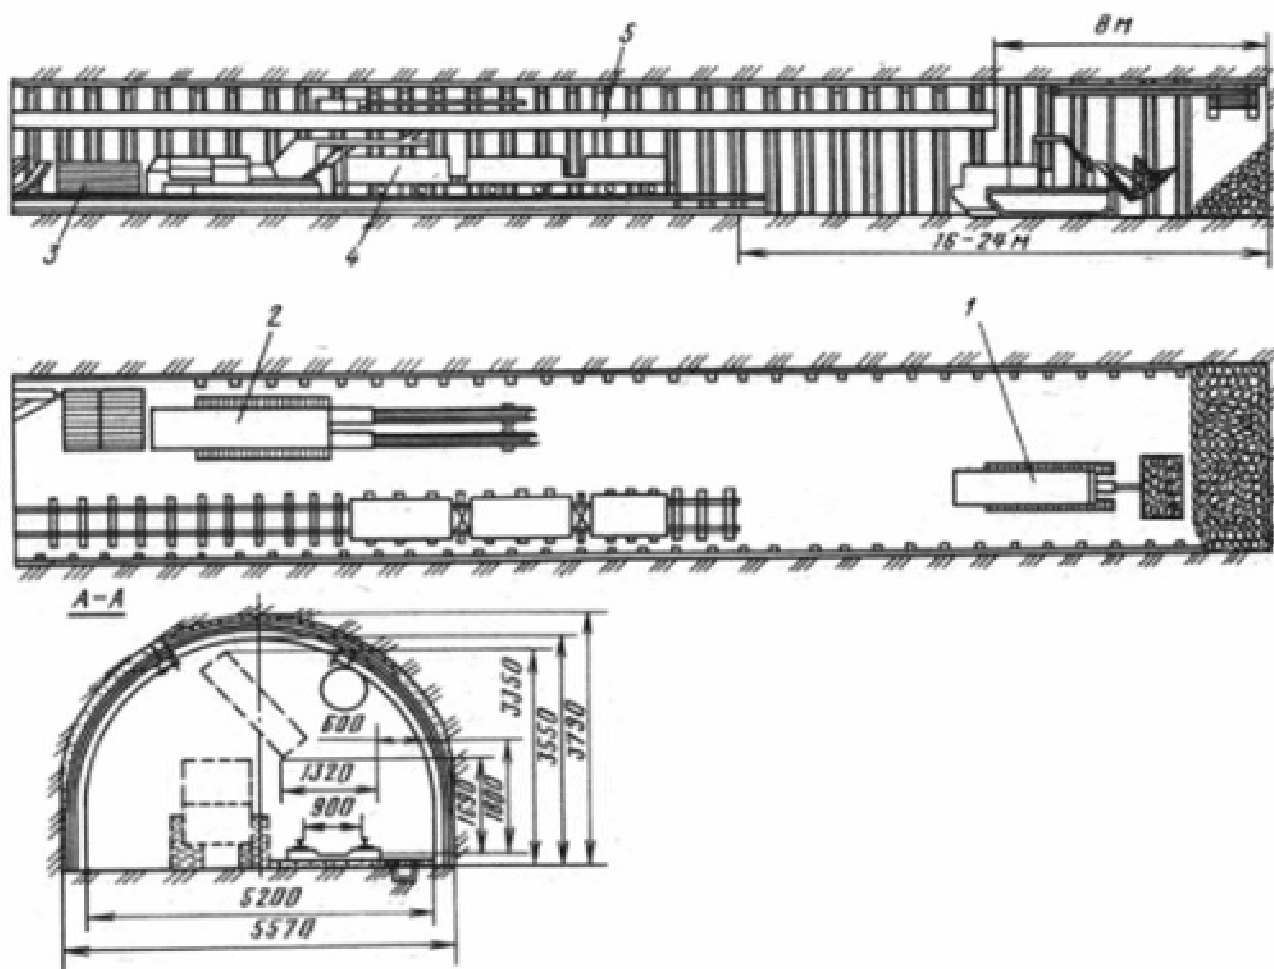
Технологическая схема проведения полевого штрека (квершлага) буровзрывным способом: 1 - машина МПК-3; 2- установка БУЭ-ЗТ; 3- склад материалов; 4- вагонетки; 5- вентиляционный трубопровод.
